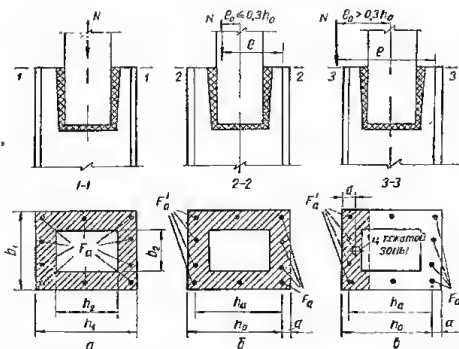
К расчету продольной арматуры стенок стакана:
